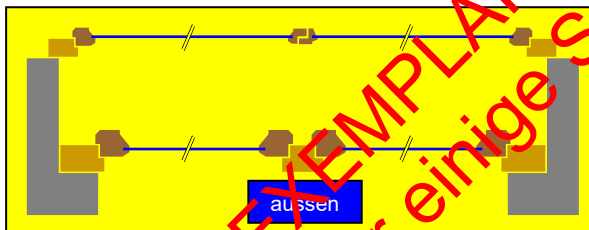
Einfachverglastes Fenster (EV) mit (innerem) EV-Vorfenster
